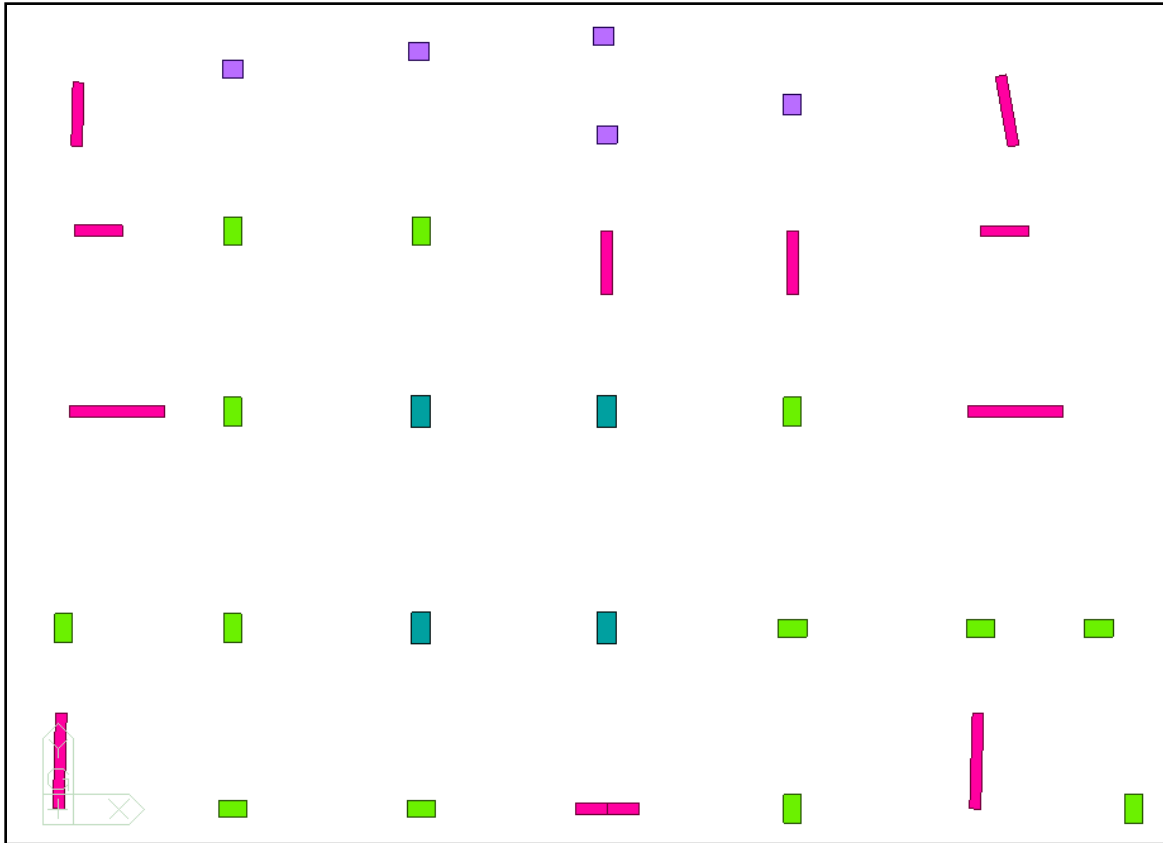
Ubicación de columnas y muros en concreto para la base del edificio.
